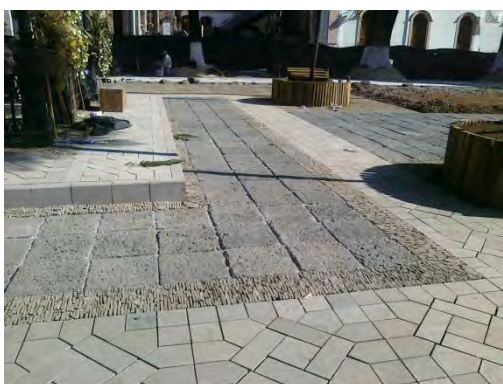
Se muestran los cambios en el piso así como en las jardineras, las piedras en formato rectangular retiradas fueron aprovechadas.
